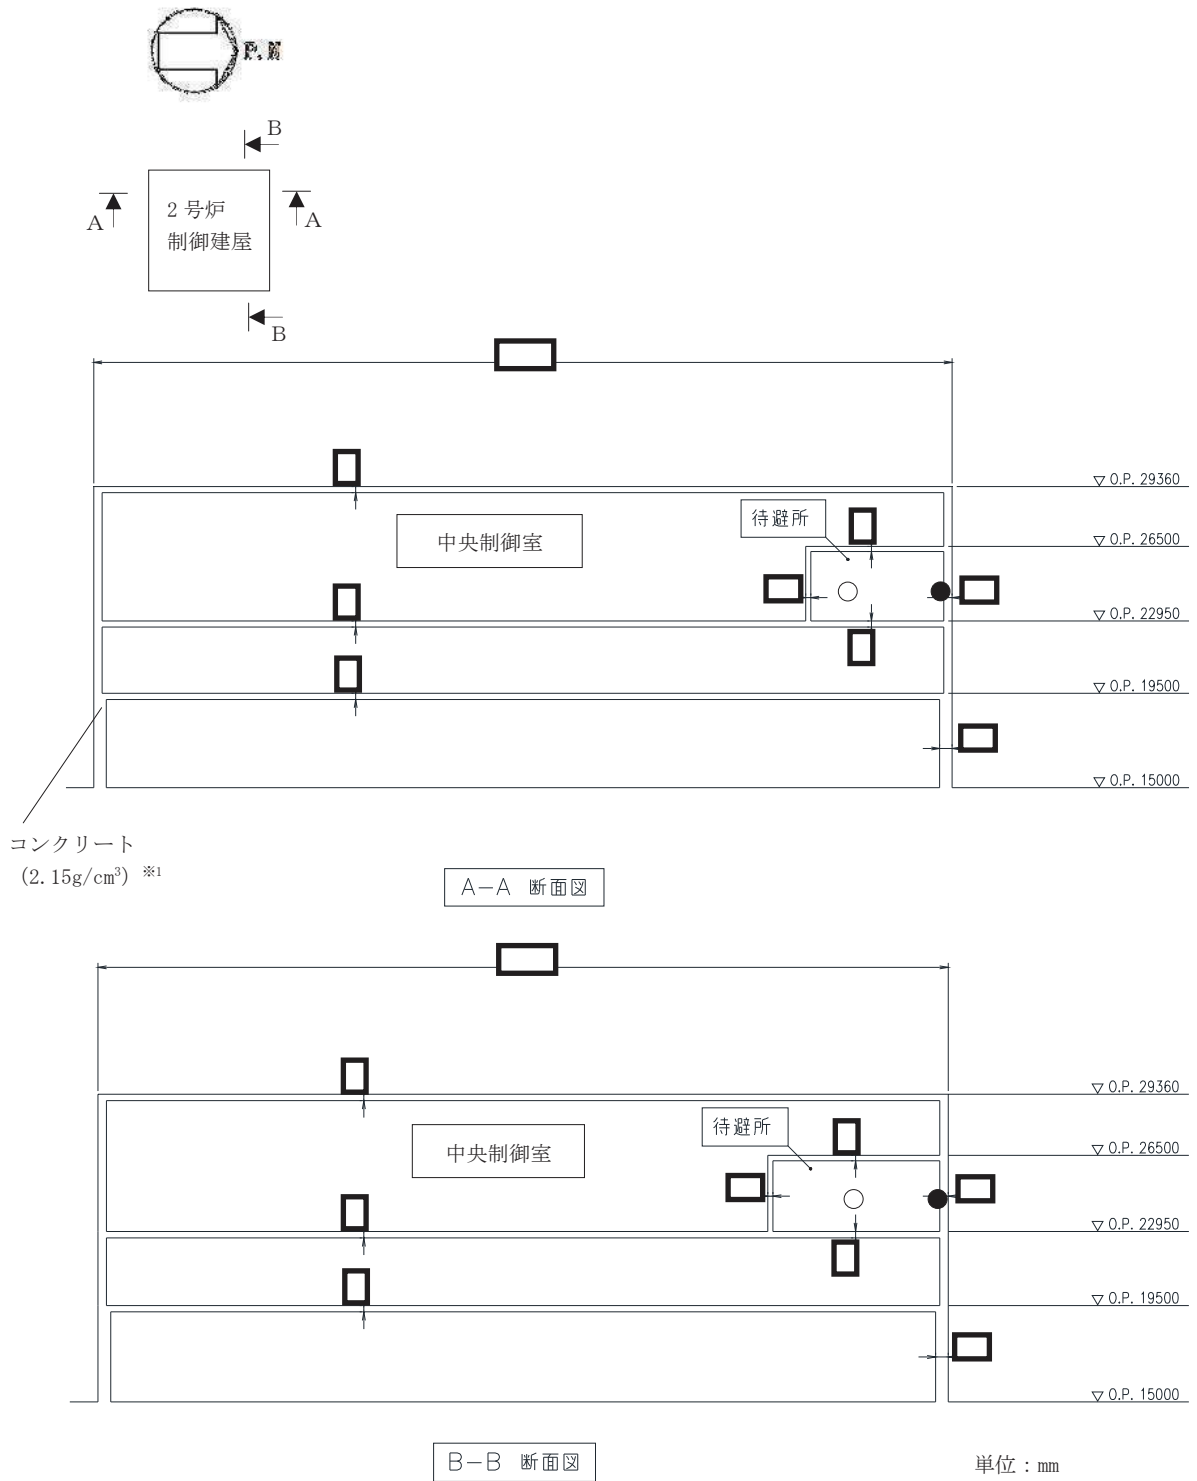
評価モデルの平面図及び評価点 (中央制御室滞在時)
